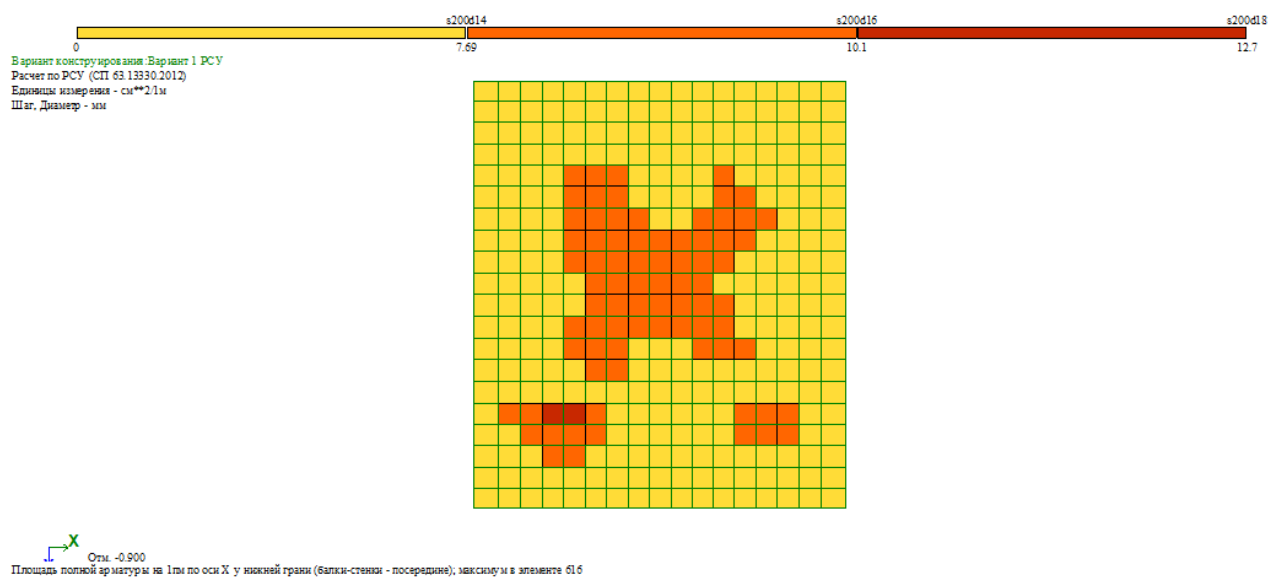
По оси X нижней грани – площадь полной арматуры 1 п.м.
